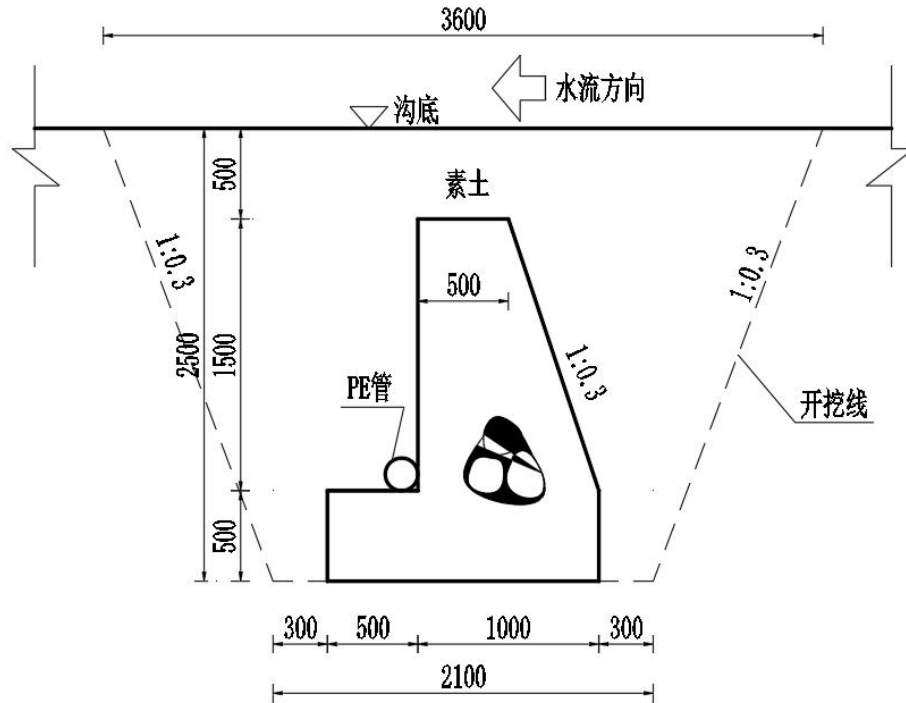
管道过沟防护工程横断面图 (单位: mm)
